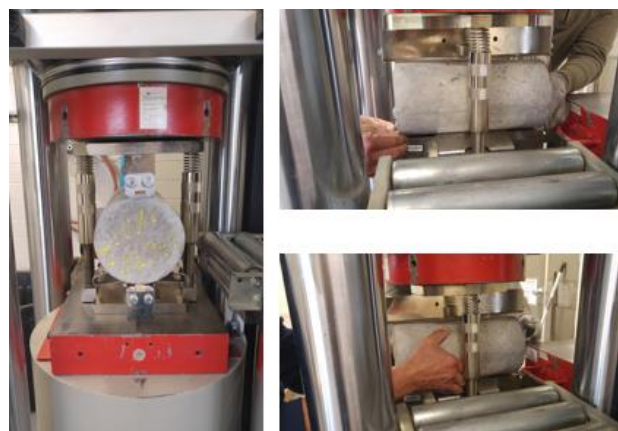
Posicionamento do provete cilíndrico na máquina de ensaio.
